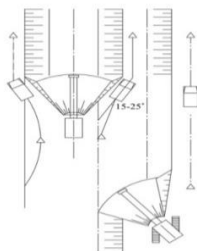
Схема торцового и бокового забоя экскаватора с обратной лопатой и драглайном
